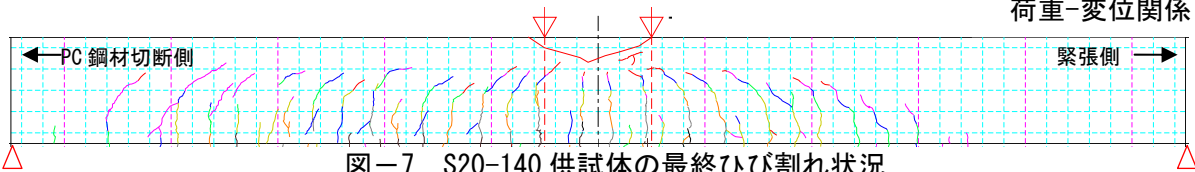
S20-140 供試体の最終ひび割れ状況
